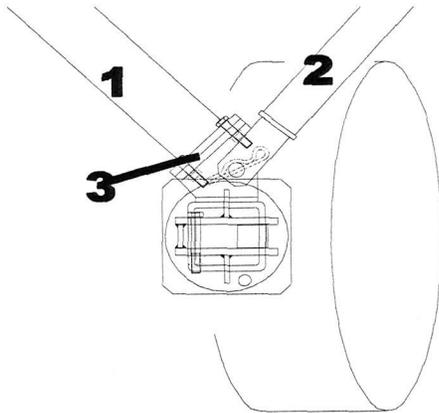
Dettaglio di fissaggio sul nastro
